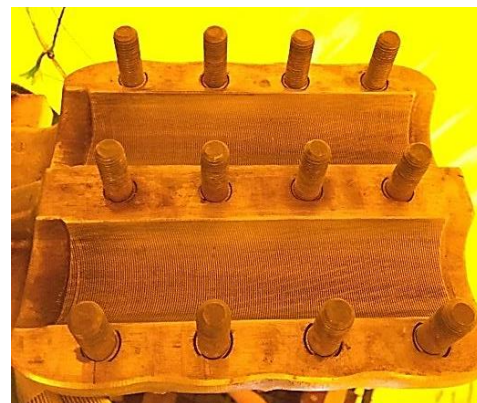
BV 2: Seilklemme (unten) nach Umbau
